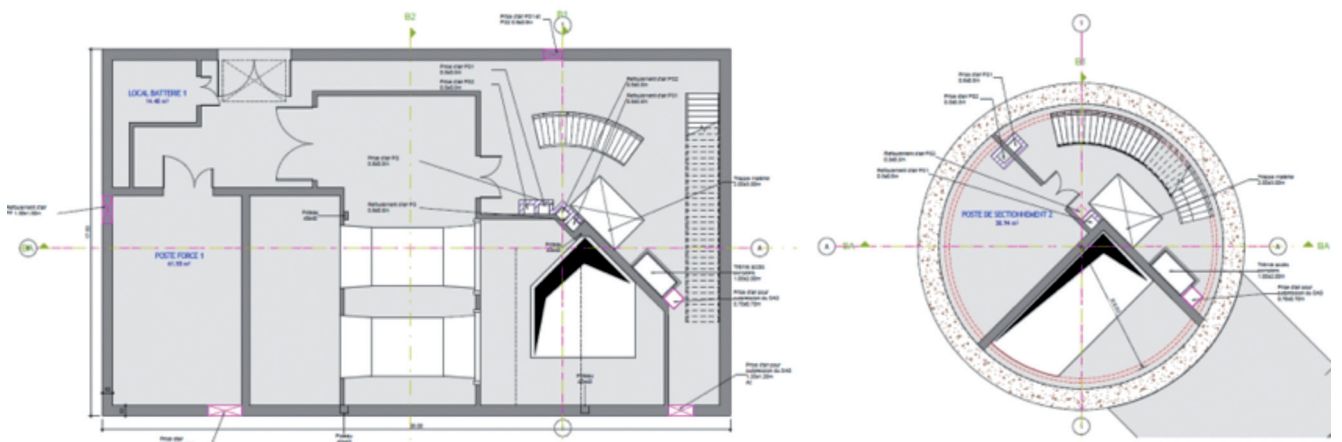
Vues en plan de plusieurs niveaux d'un puits type 7
